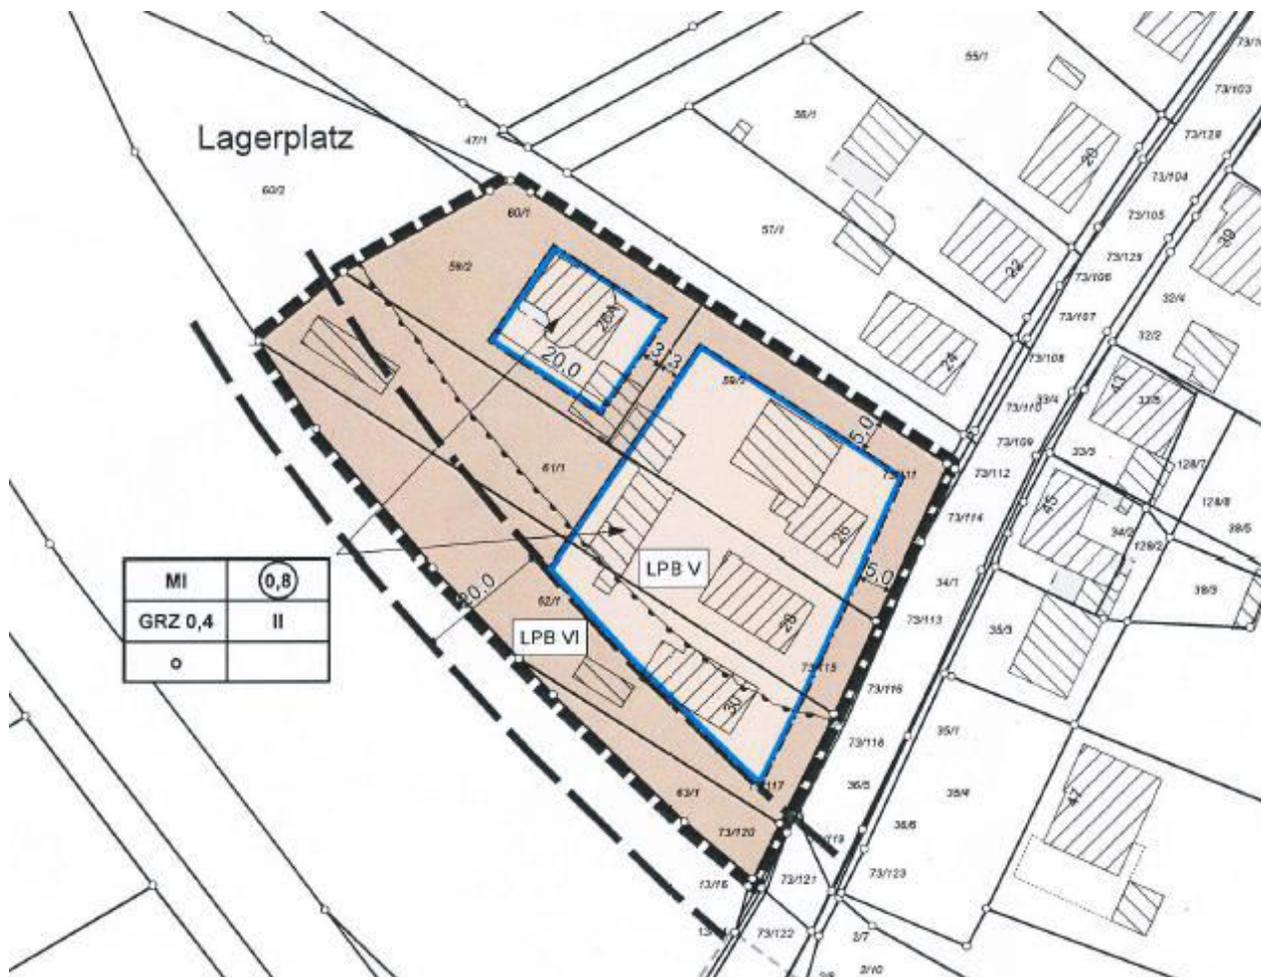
Plangebiet 7. Änderung der Bebauung, Nr. 54 Stadt Meppen „In der Marsch“
